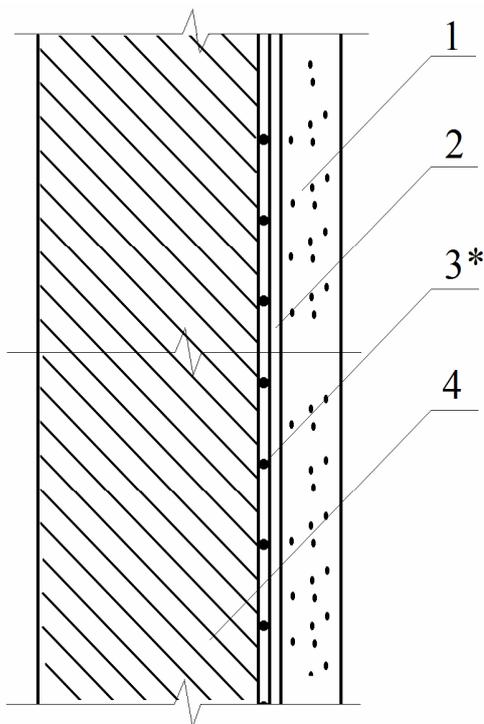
Ремонтные составы для бетонных конструкций и плит
